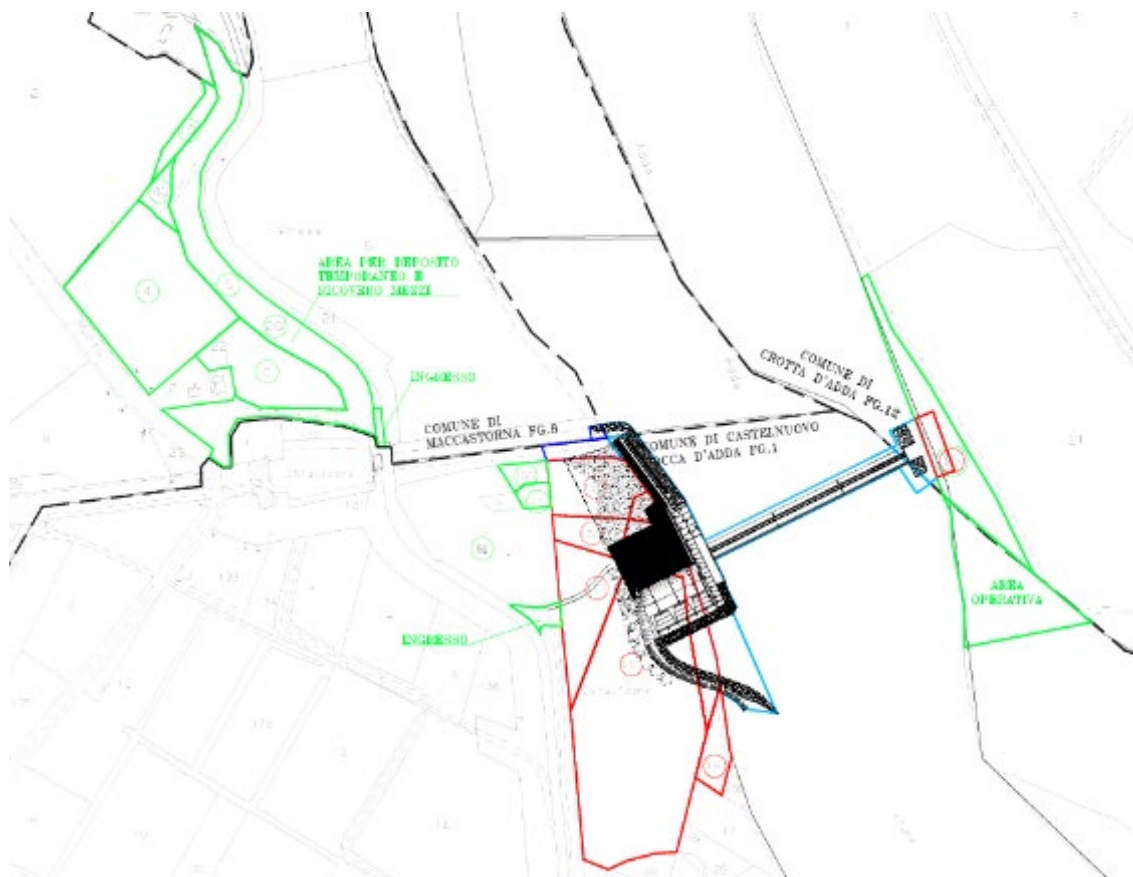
Stralcio estratto di mappa con indicazione dei mappali interessati dalle opere in progetto e dalle aree di cantiere
